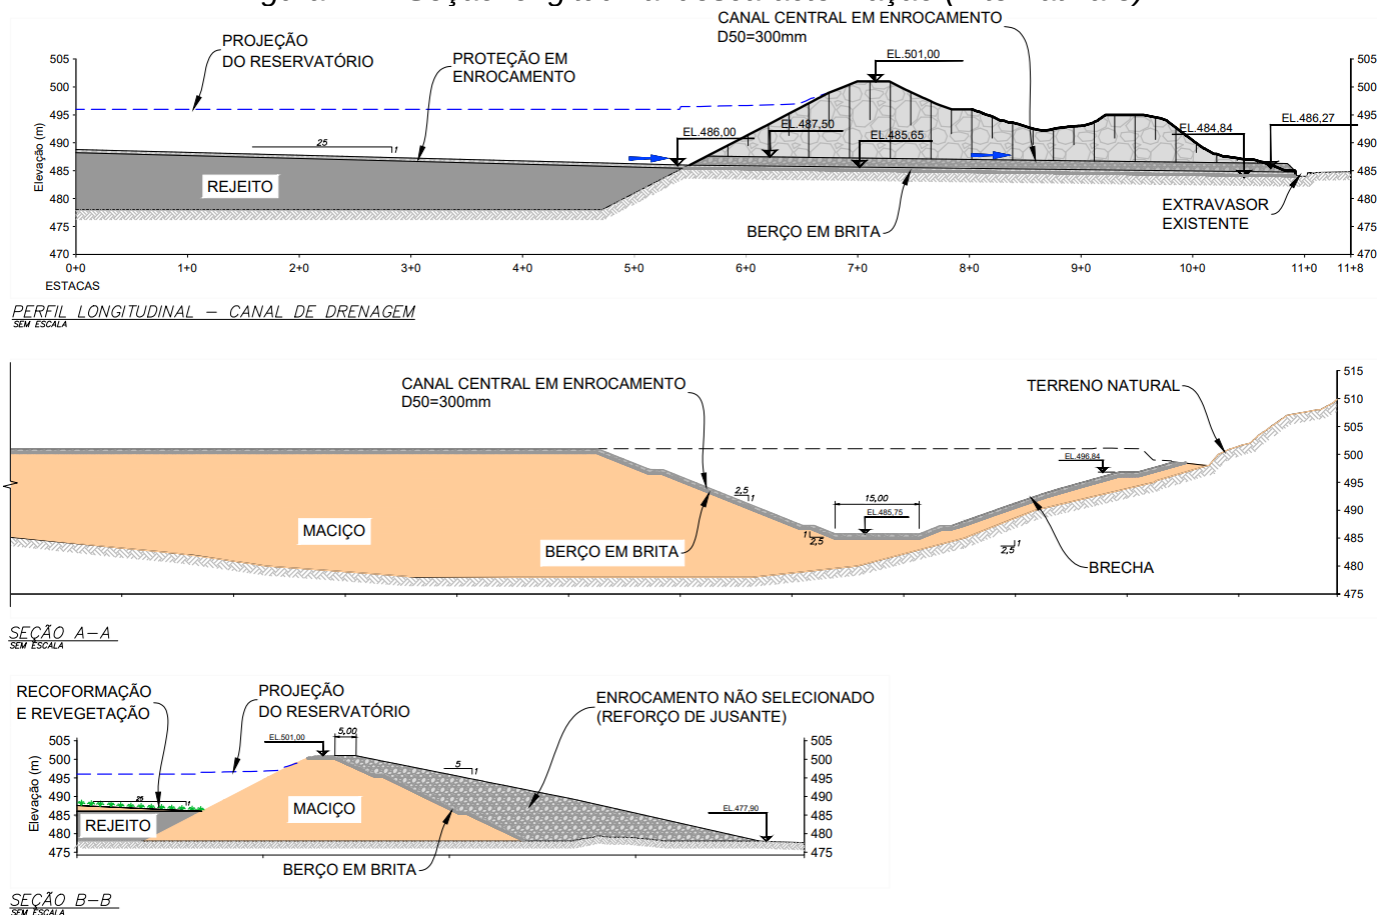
Croqui esquemático descaracterização (Alternativa 3)
